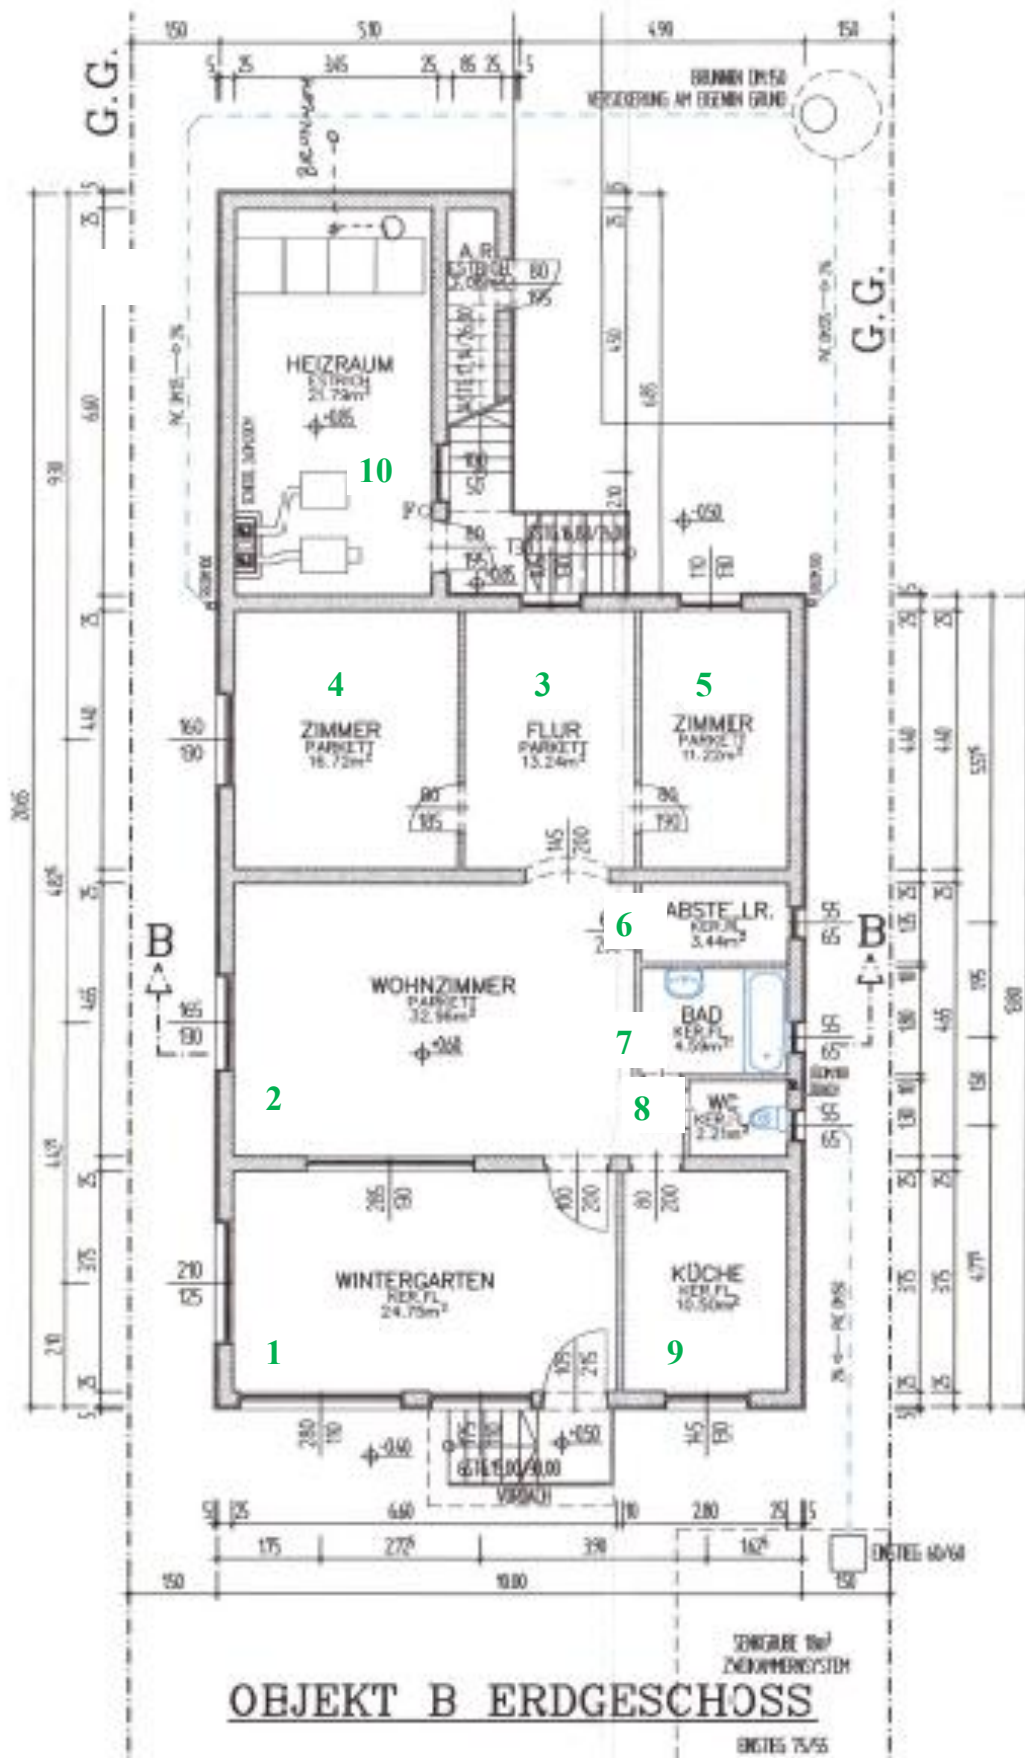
Grundrissplan Erdgeschoss; Quelle: Bauakt (Bestandsplan 1999)
